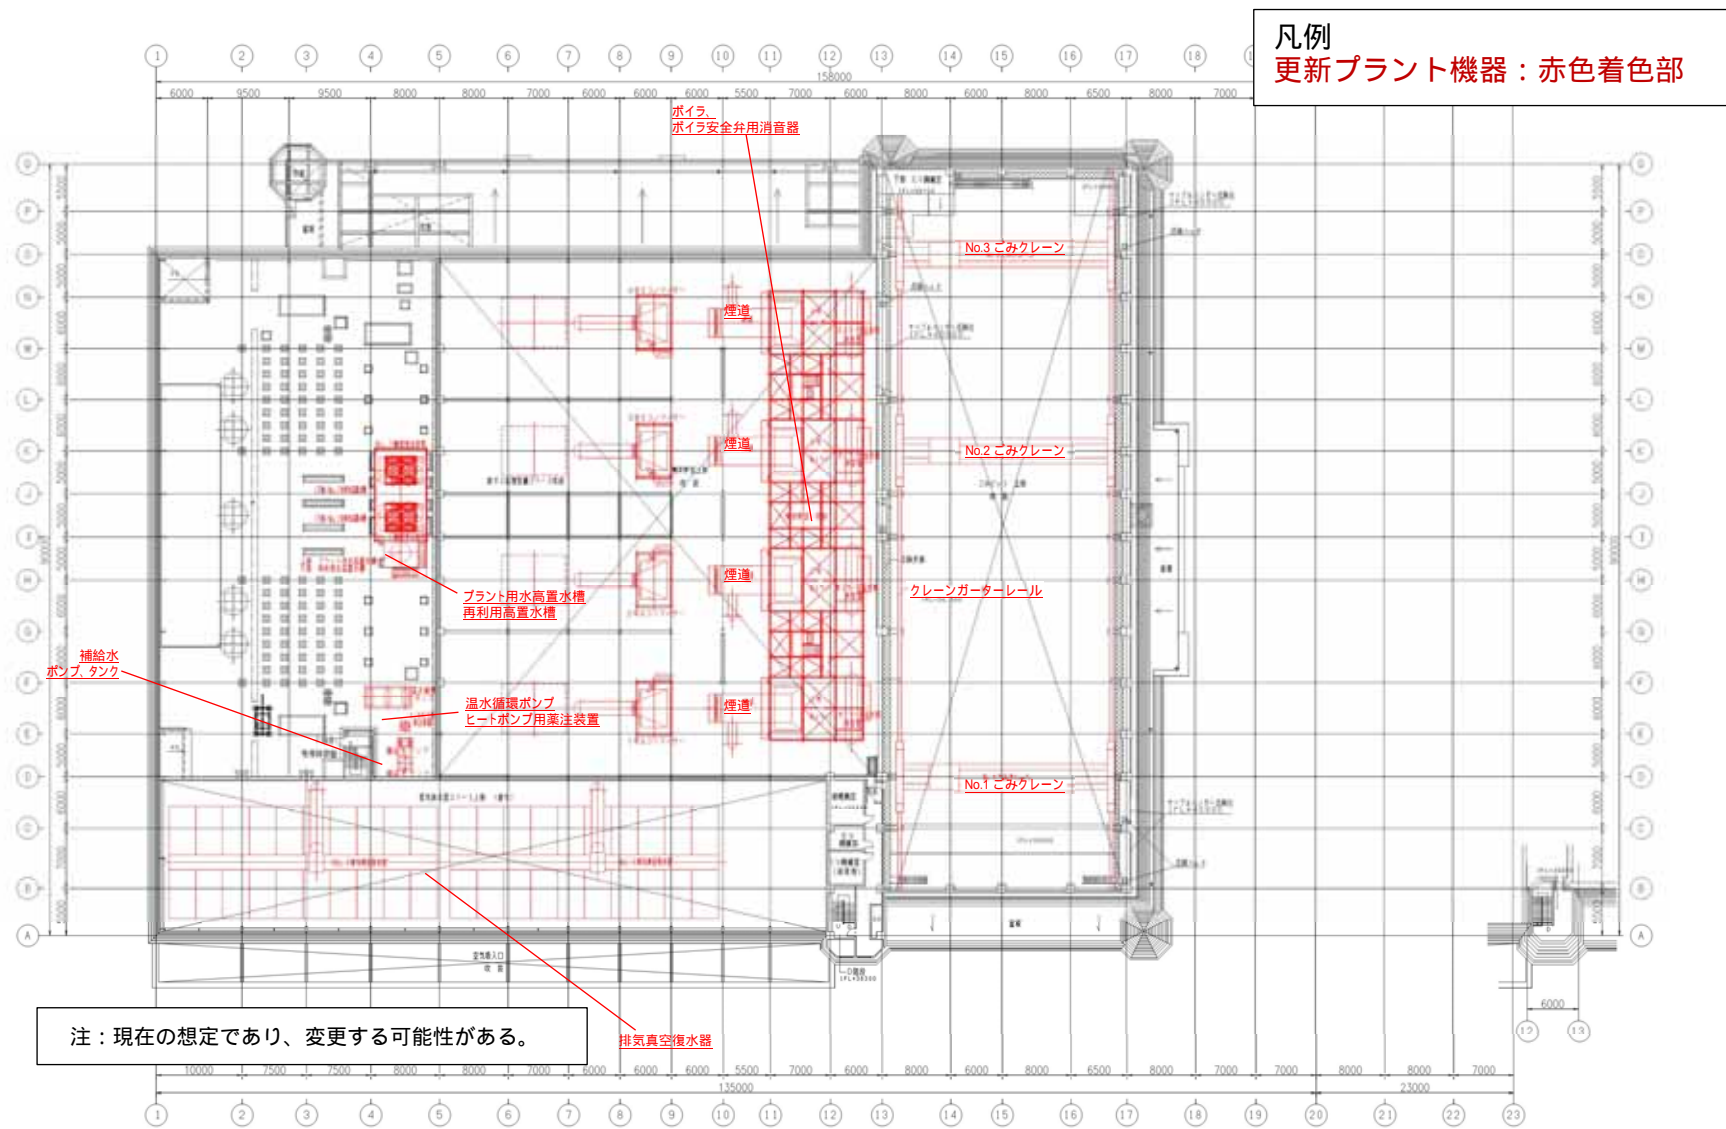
(8) 設備機器の更新箇所（クレーン階平面図）
